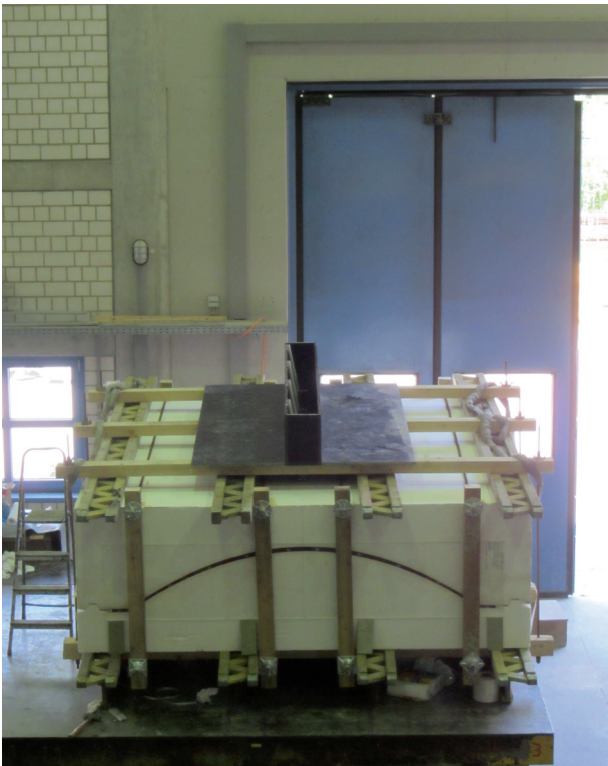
Betonierfertige Schalung im Labor für Konstruktiven Ingenieurbau der TU Kaiserslautern
